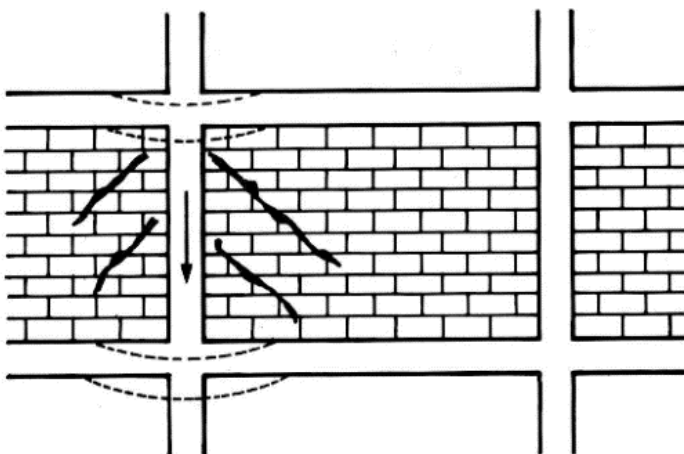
Fissuras devido à deformação dos elementos estruturais em balanço
